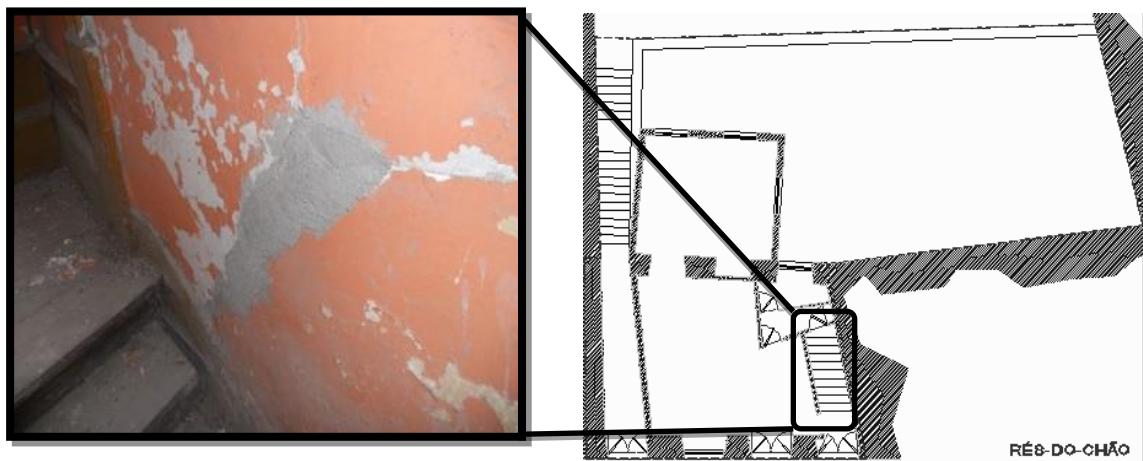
Anomalia 10 - Fotografia e localização em planta
